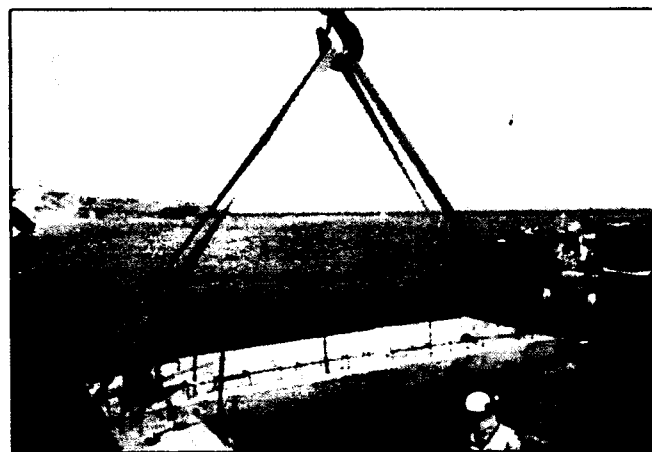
Transporte y colocación de losas nervadas en el cabezo.
